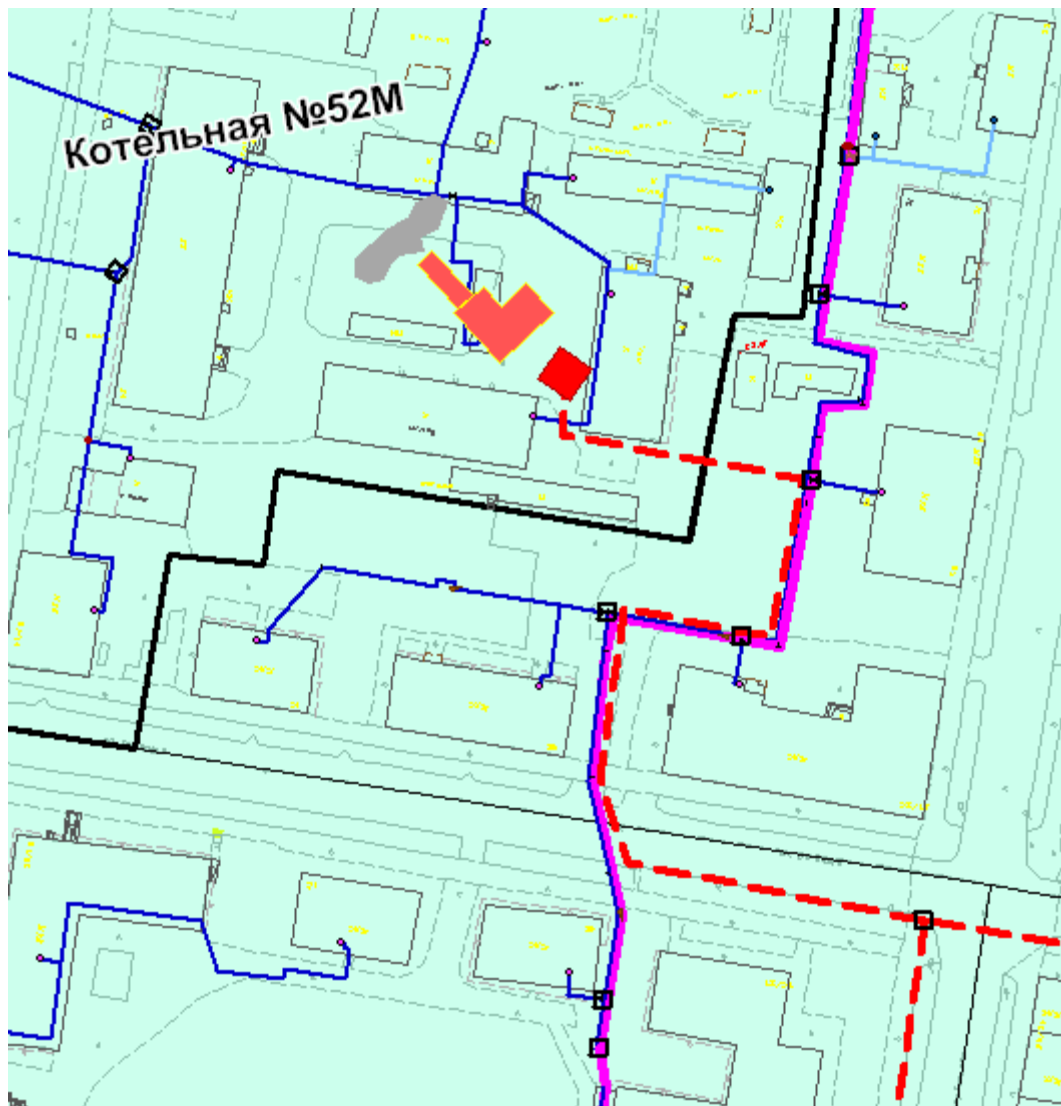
Схема прокладки трубопровода до котельной №52М
